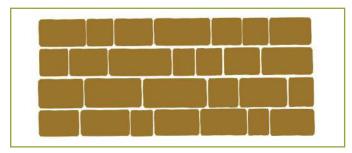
Schéma d'un muret où les pierres sont montées en appareillage ajusté (Dessin de Cédric Houel)
